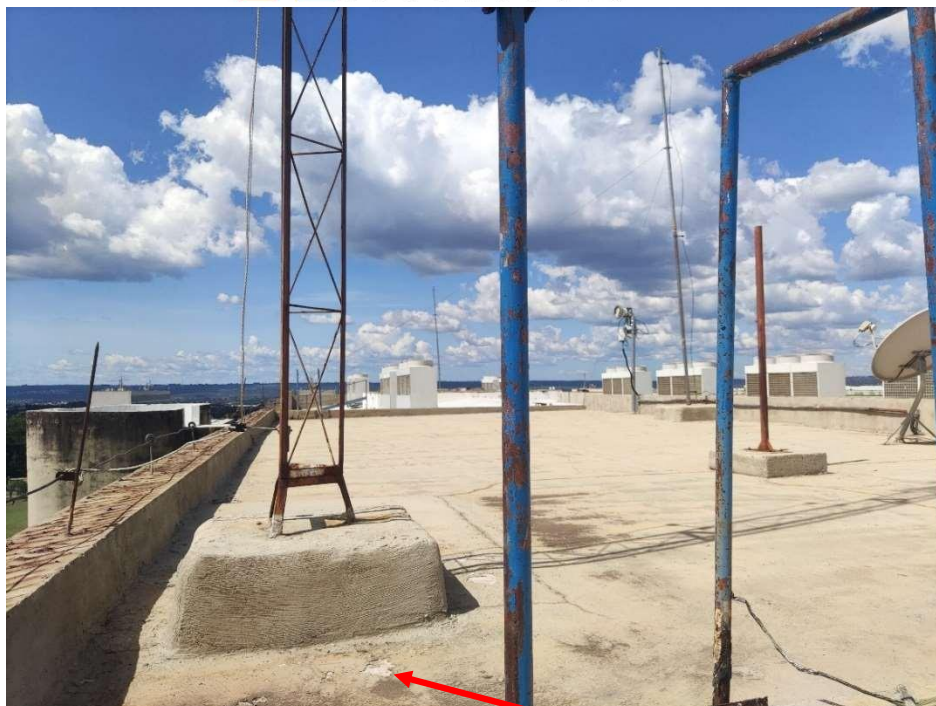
Sistema de impermeabilização em estado avançado de degradação
